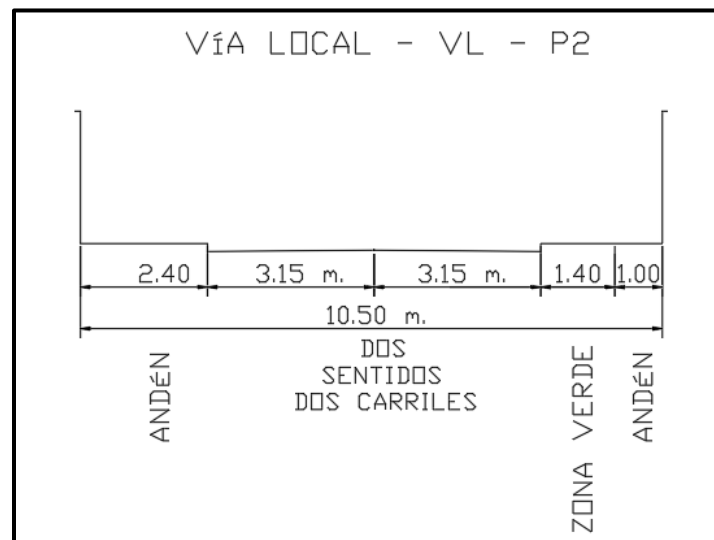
Sección vial 8-8'. Fuente: Elaboración propia.
